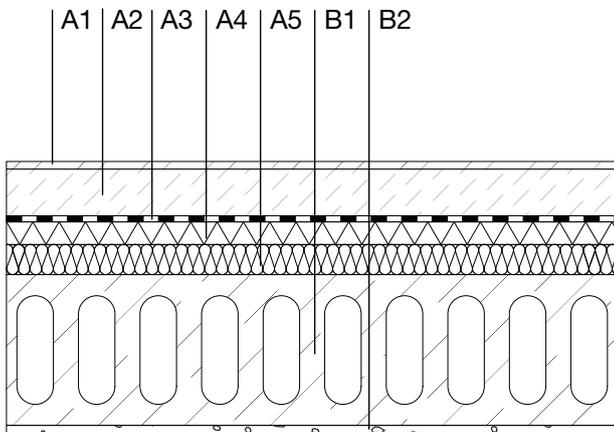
Vertikalschnitt Geschossdeckenaufbau DE2, M 1:10
